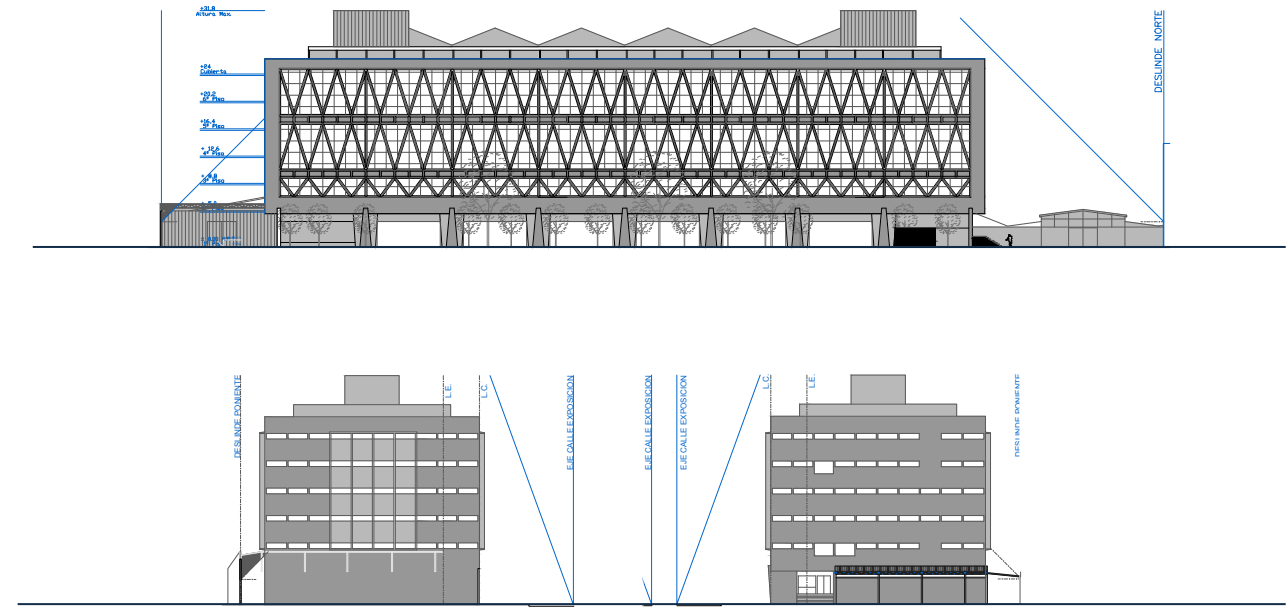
Elevaciones fachadas | En orden fachada Sur, Oriente, Norte
